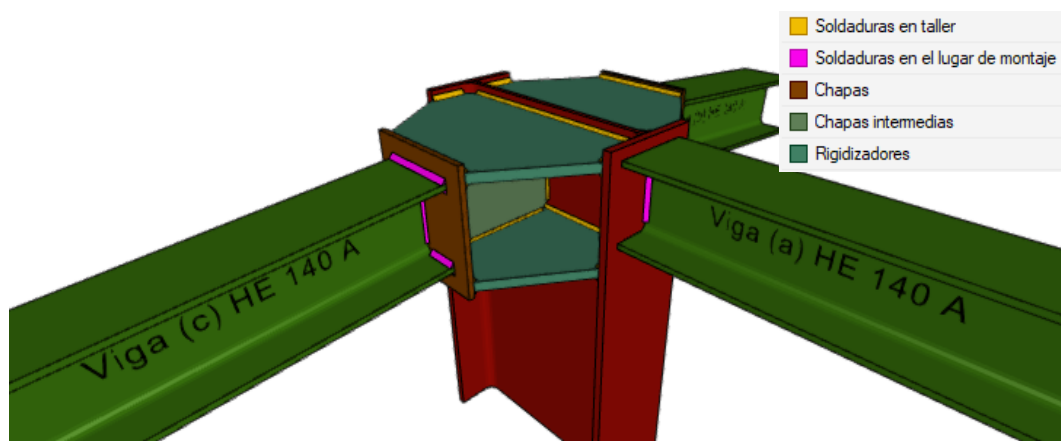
Unión tipo 2. Unión de dinteles hastiales, pilar central de fachada y viga perimetral de cubierta.
